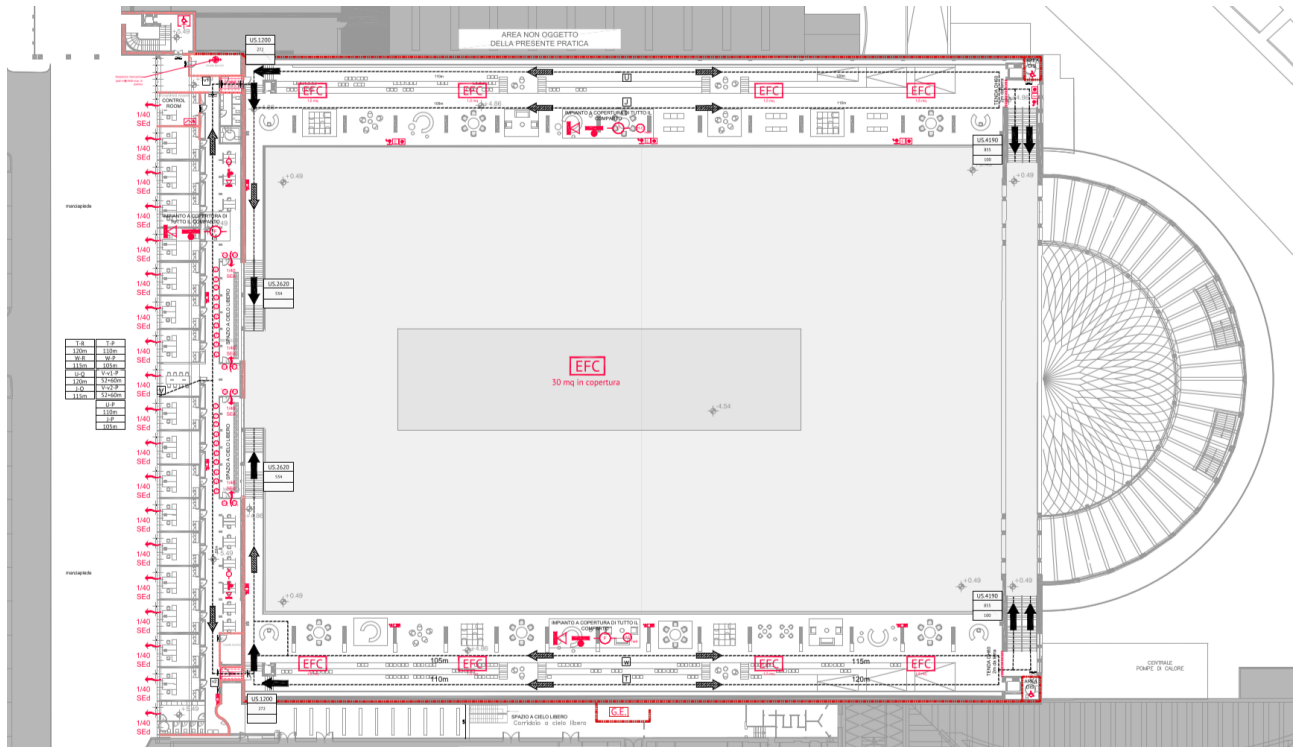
Progetto di prevenzione incendi - Pianta Piano Primo
